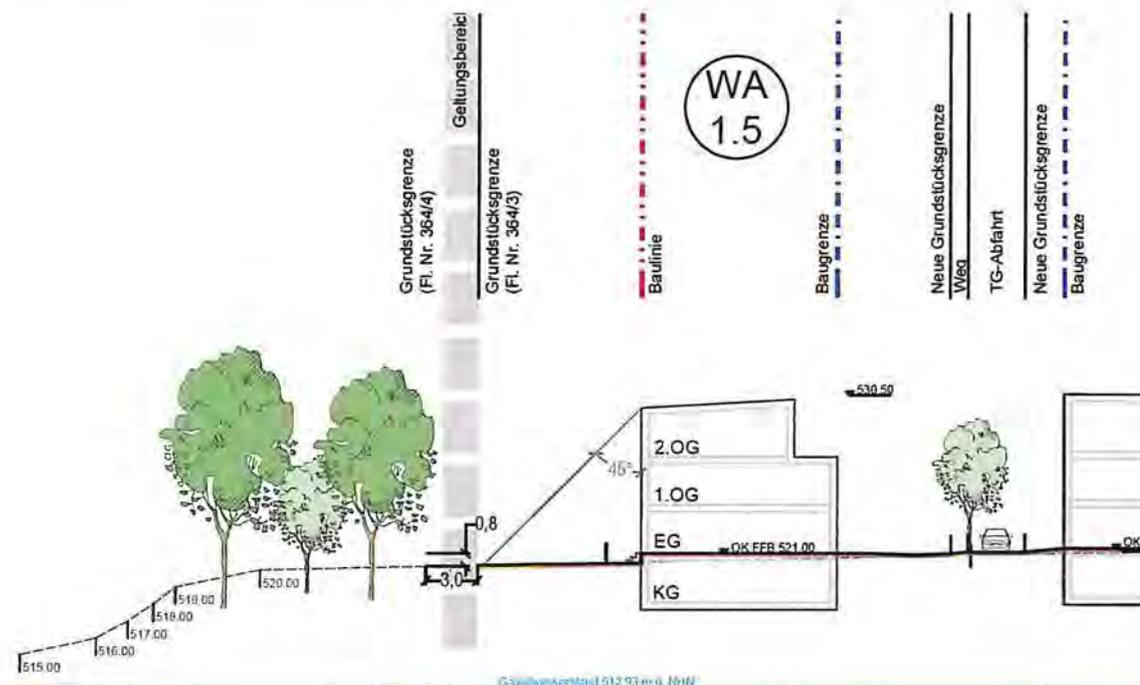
Ausschnitt aus Schnitt D-D, o.M.
